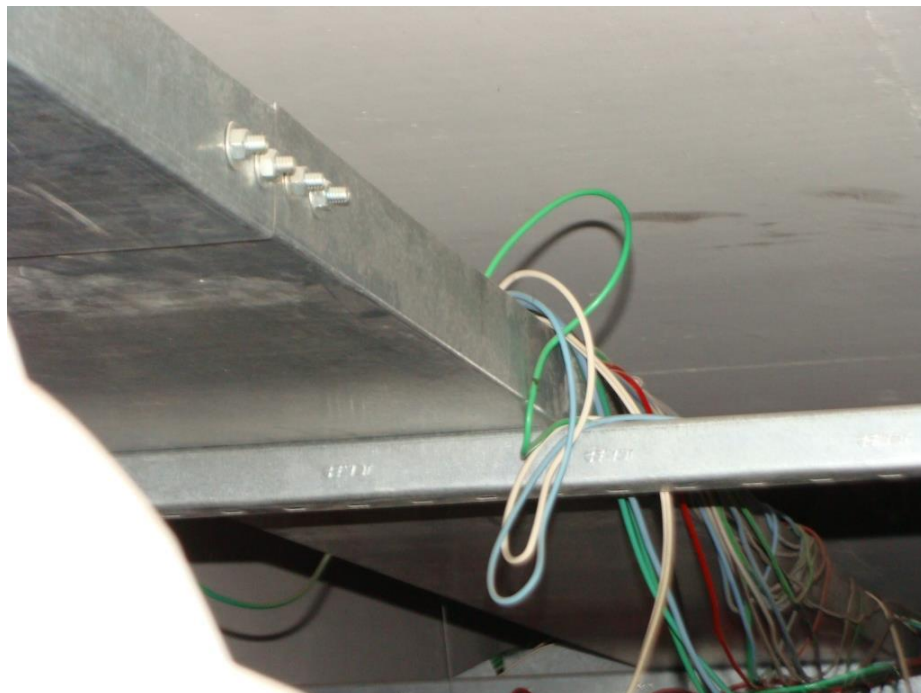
Laje do 6º pavimento (02/03/2021)
